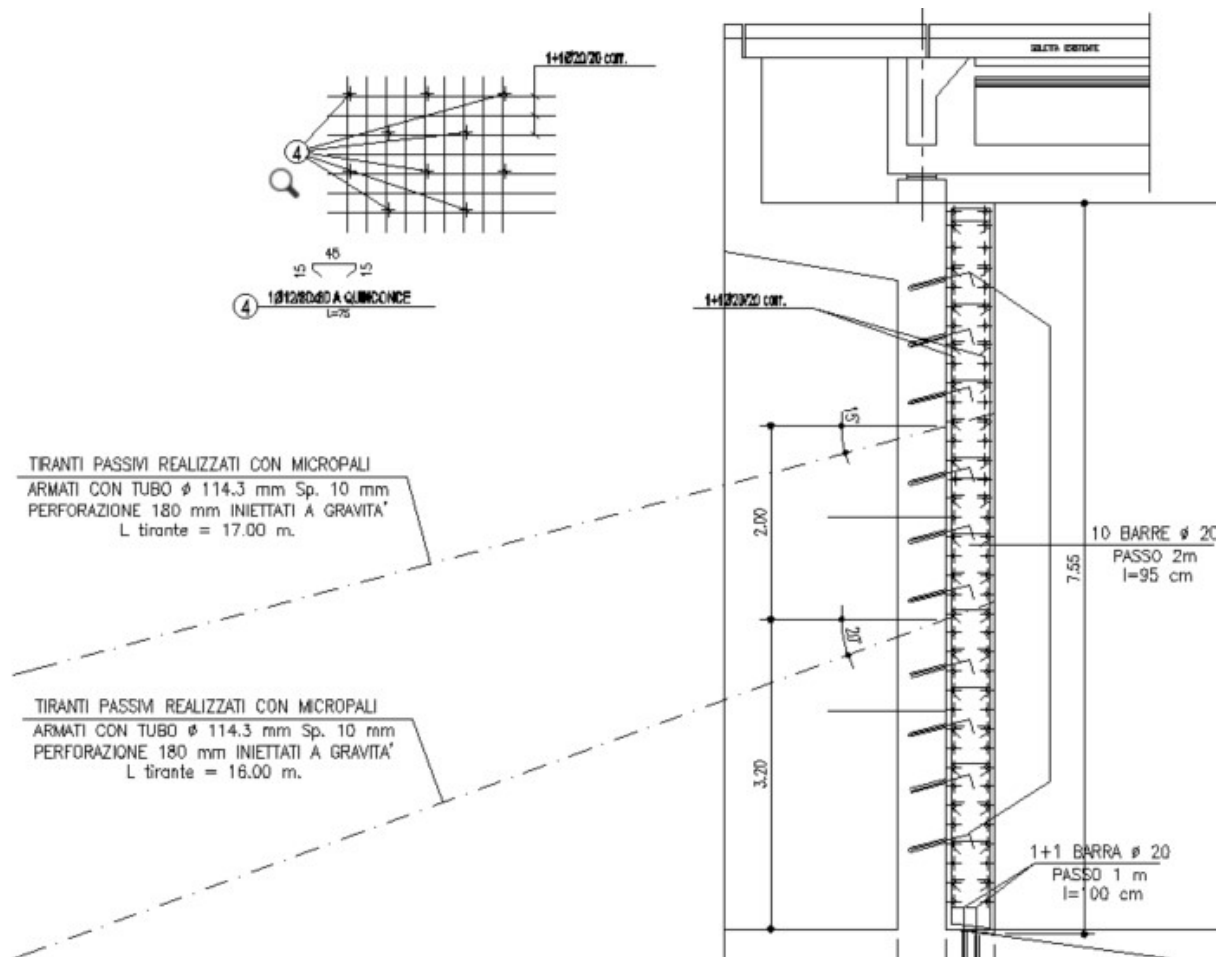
Spalle – Sezione tipo rinforzo strutturale
